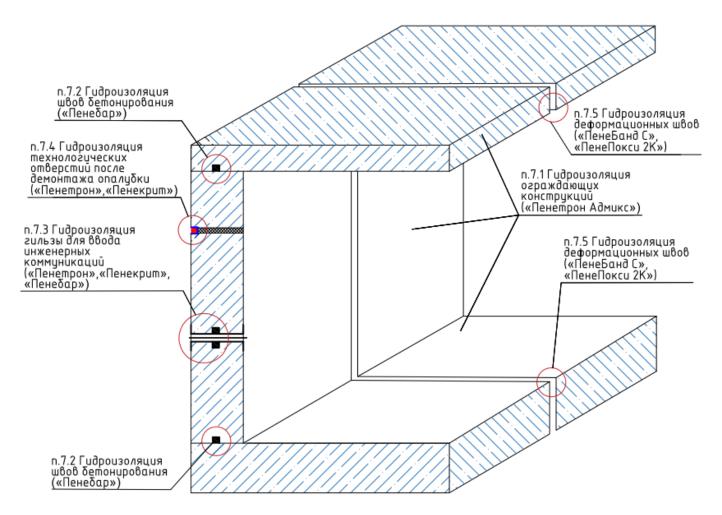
Схема гидроизоляции конструкции на стадии строительства
